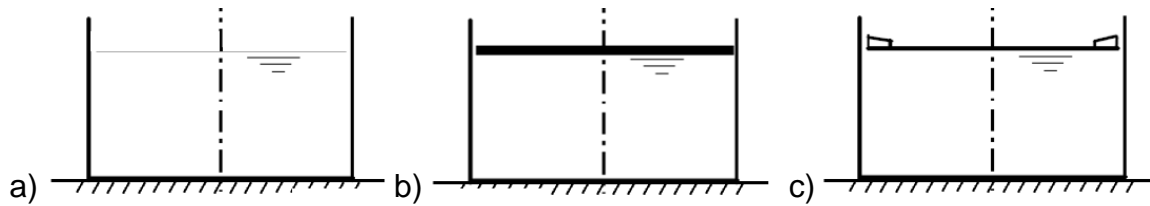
a) Serbatoio a superficie libera, b) Serbatoio con tetto galleggiante a doppio pontone c) Serbatoio con tetto galleggiante a singolo pontone
